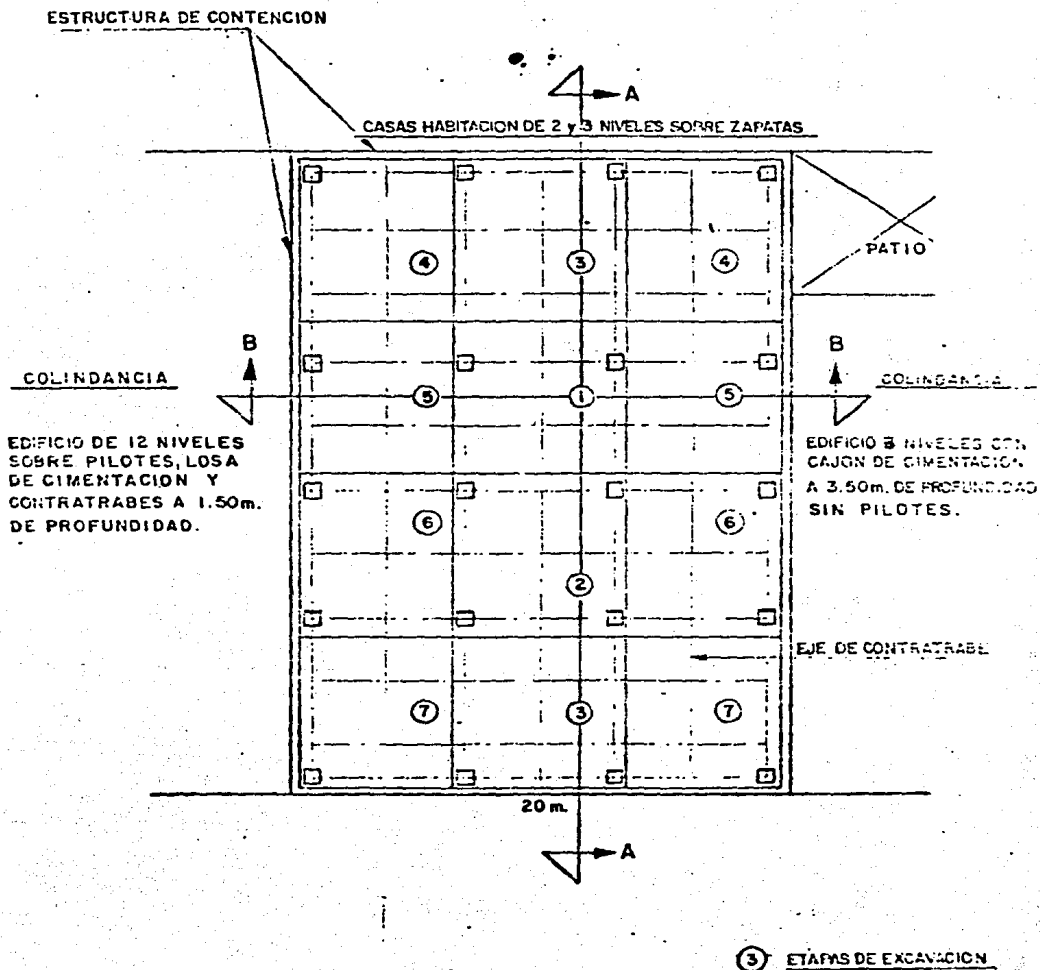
ETAPAS DE EXCAVACION Y PROCEDIMIENTO CONSTRUCTIVO
